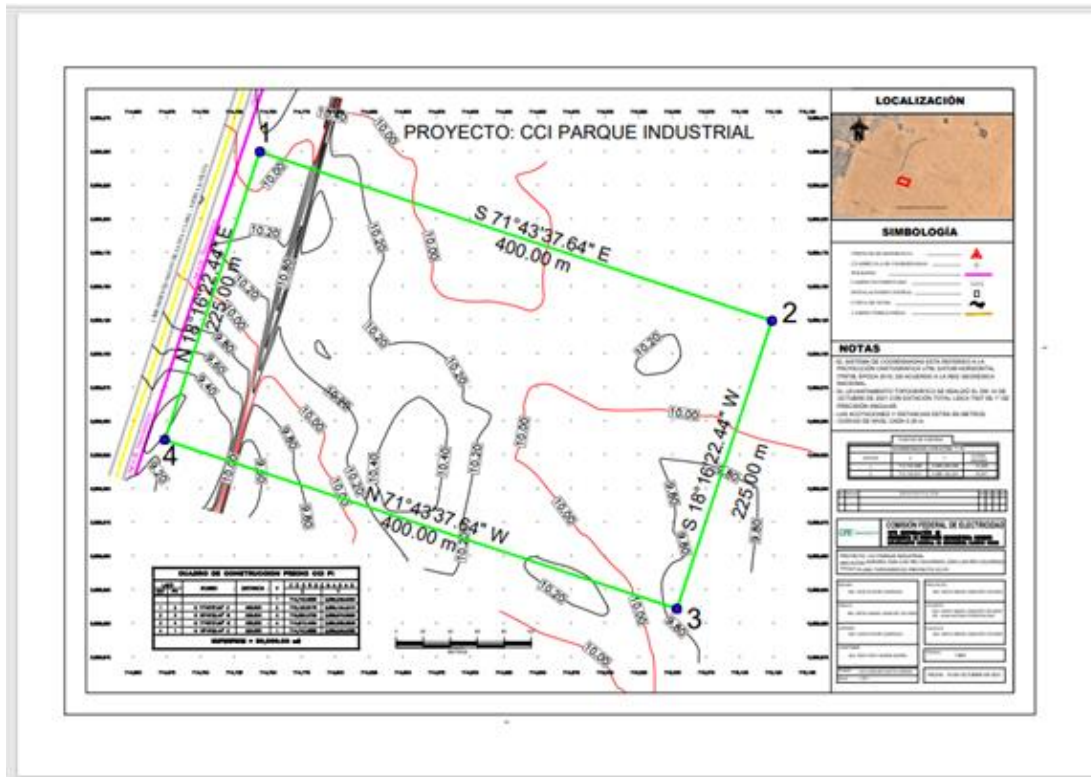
Plano topográfico del predio donde se instalará el proyecto
